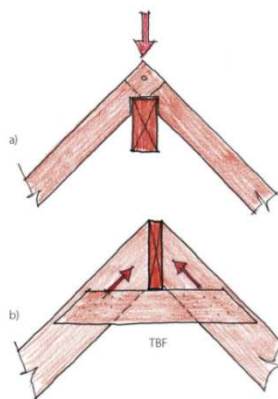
Napojení jednotlivých částí konstrukce [9]
